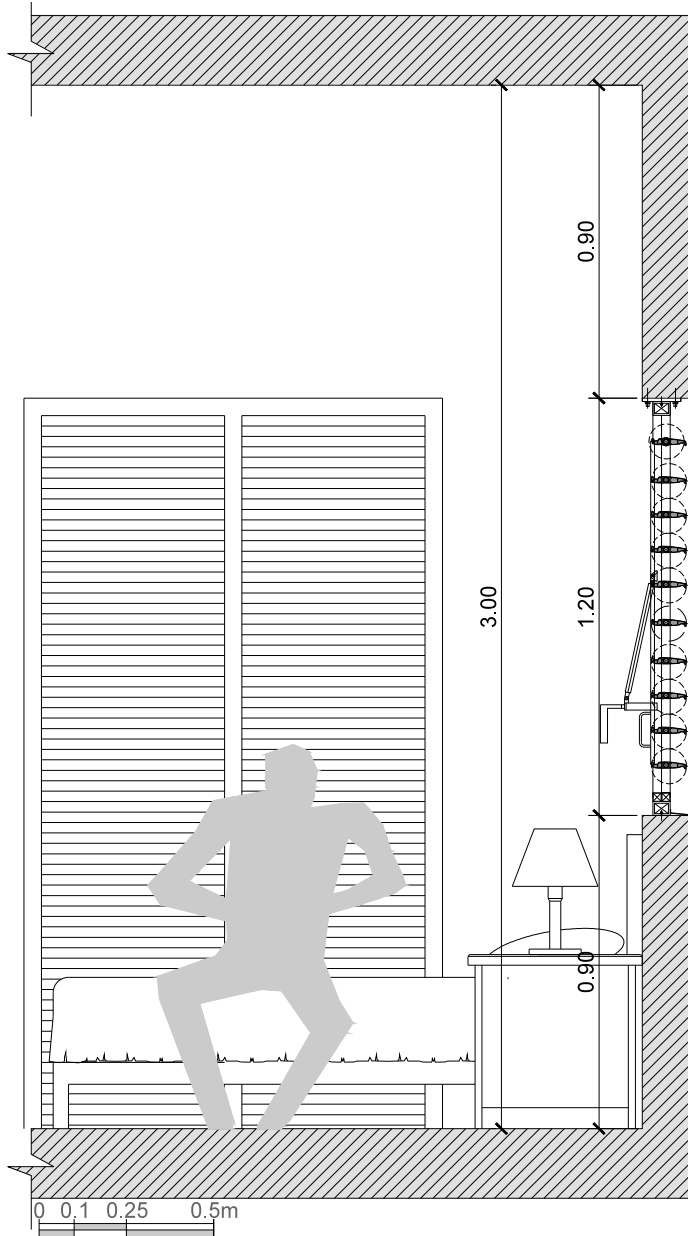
Sección propuesta, caso 2, protección en ángulo, dormitorio.
